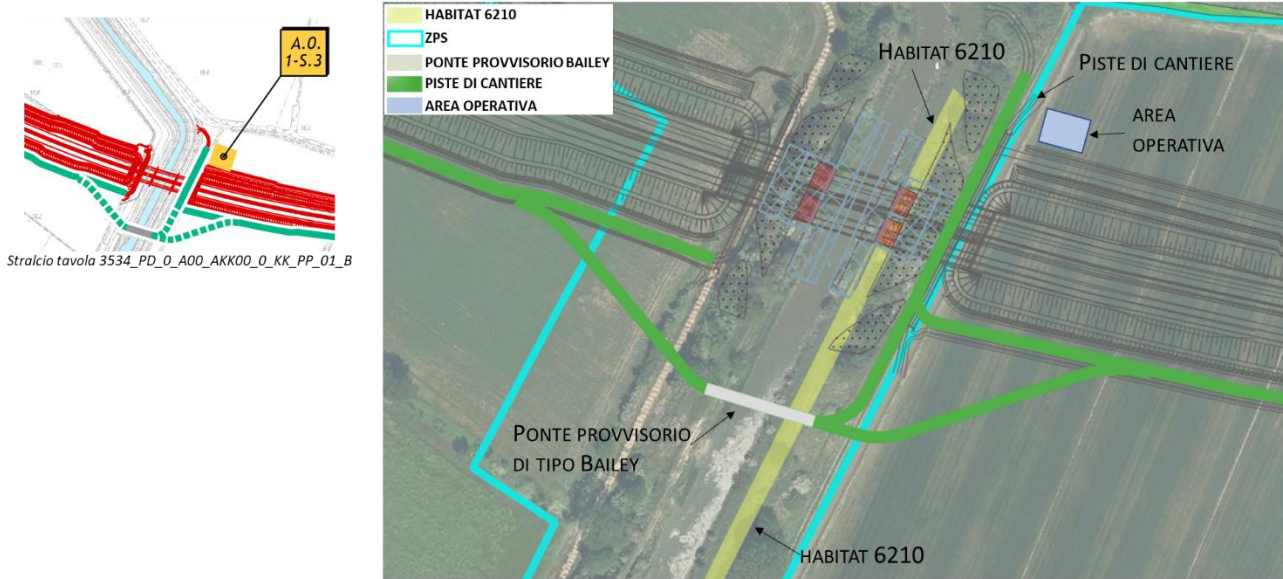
Viabilità di cantiere - Viadotto APO02
